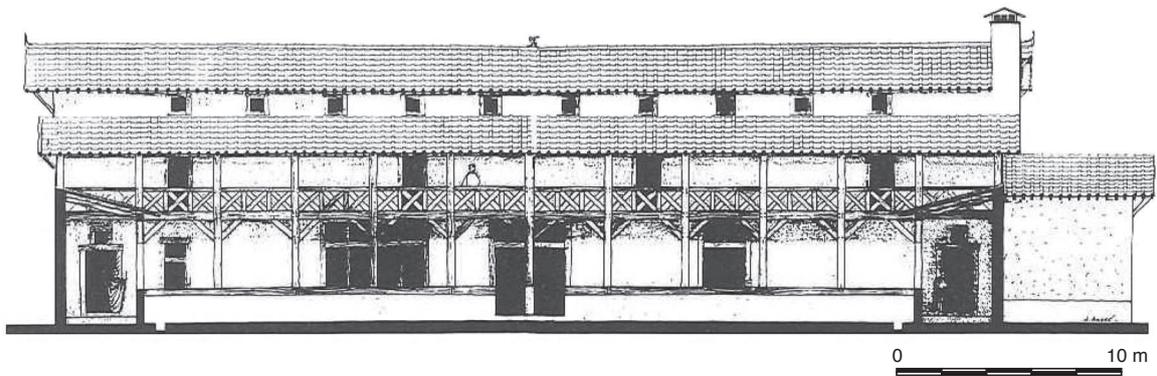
Essai de reconstitution de la façade du bâtiment principal par Pierre André.
